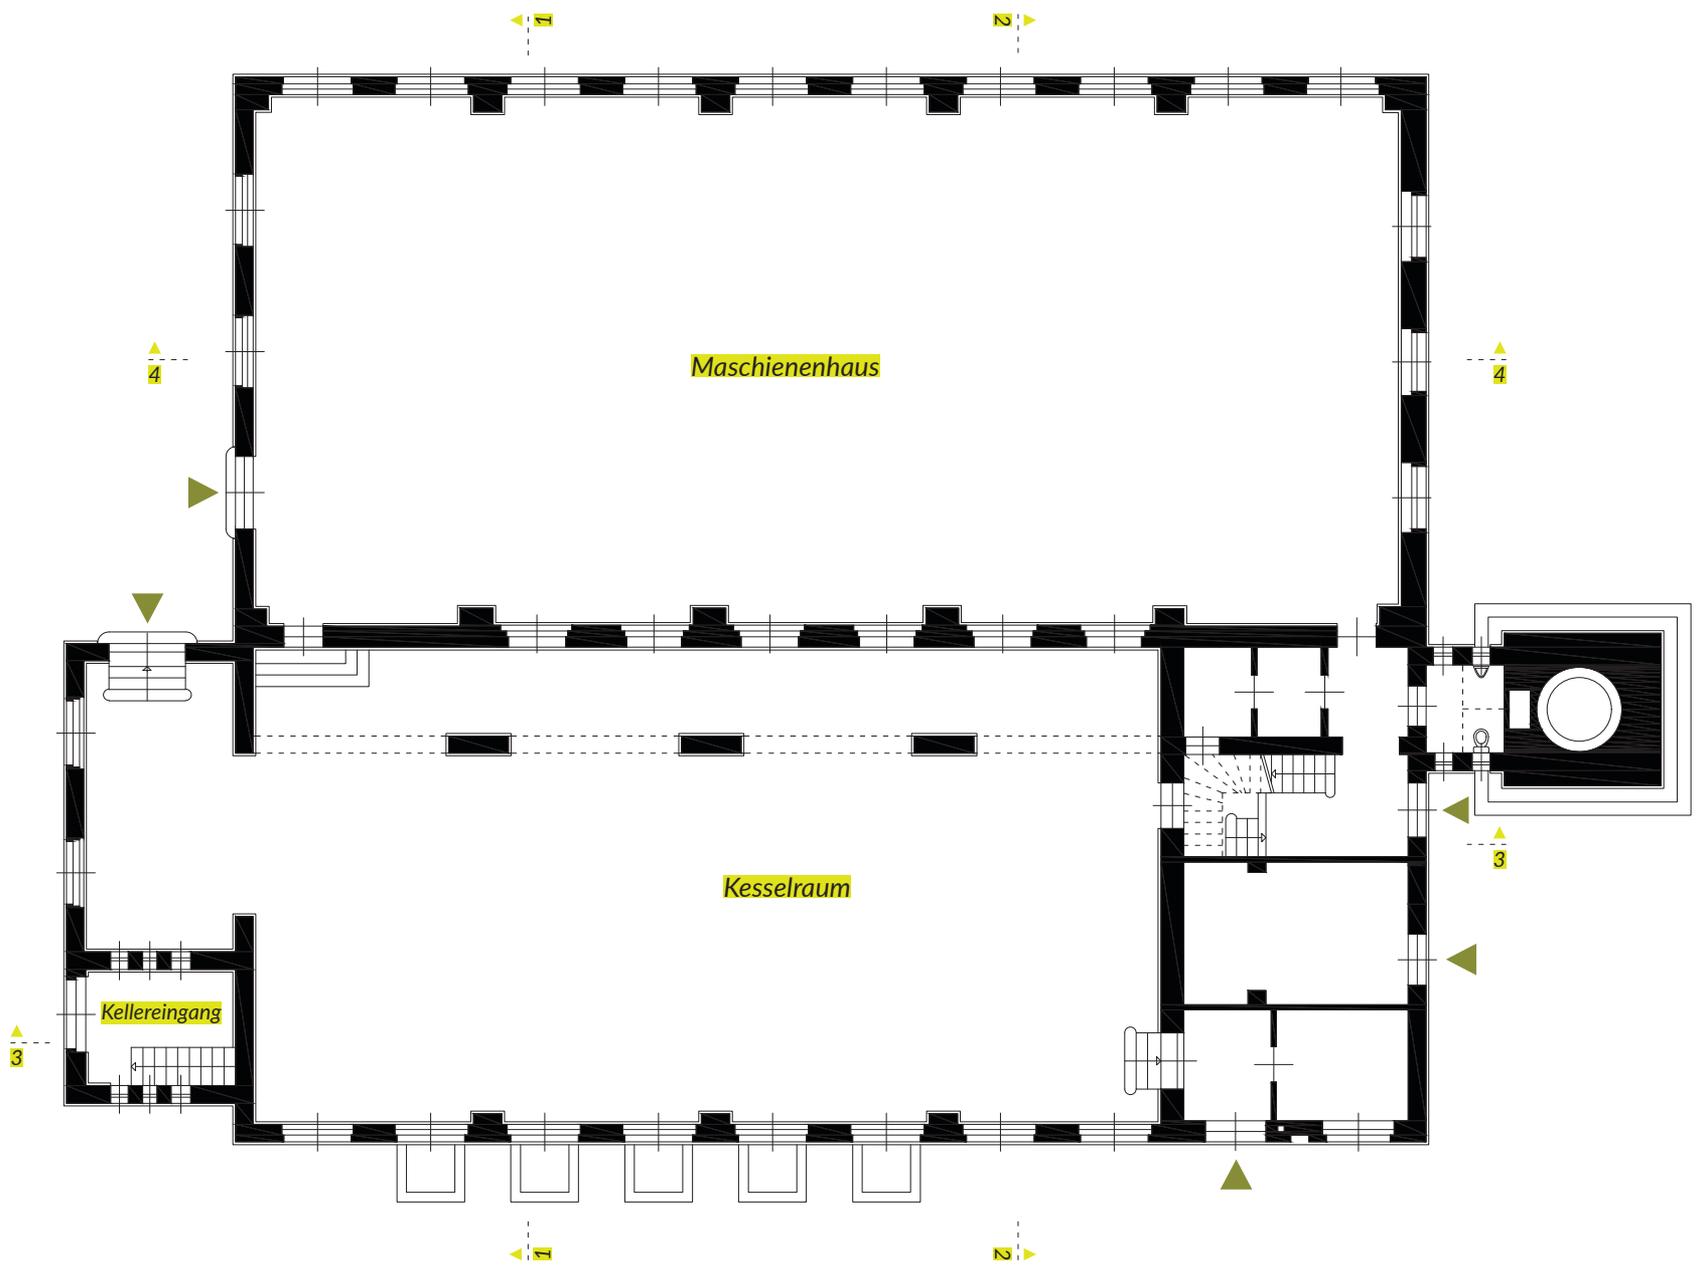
Elektrizitätswerk Grundriss M 1:200 (Stand 1885)
